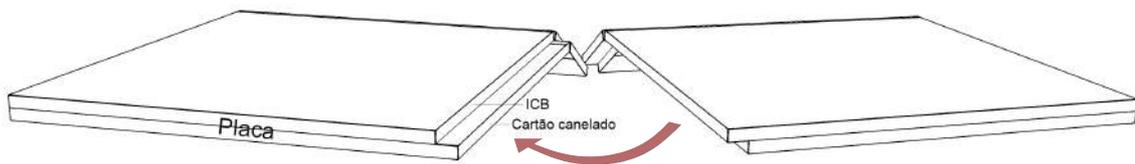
| Planta com camadas dos materiais que compõem a estrutura do abrigo. Esc. 1:10.
